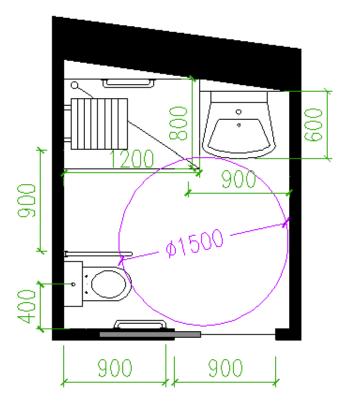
Detalle del baño adaptado de la planta inferior de la vivienda.
